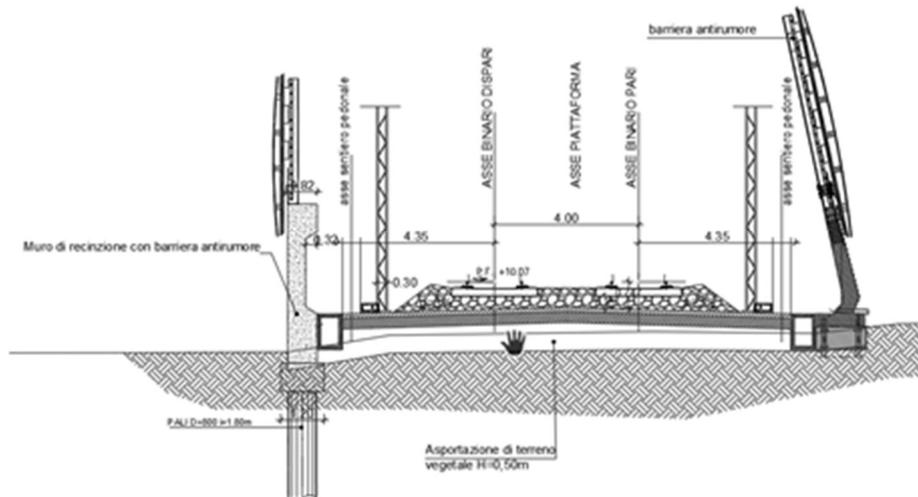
sezione tipo in rilevato in corrispondenza della ex stazione di Pieris
